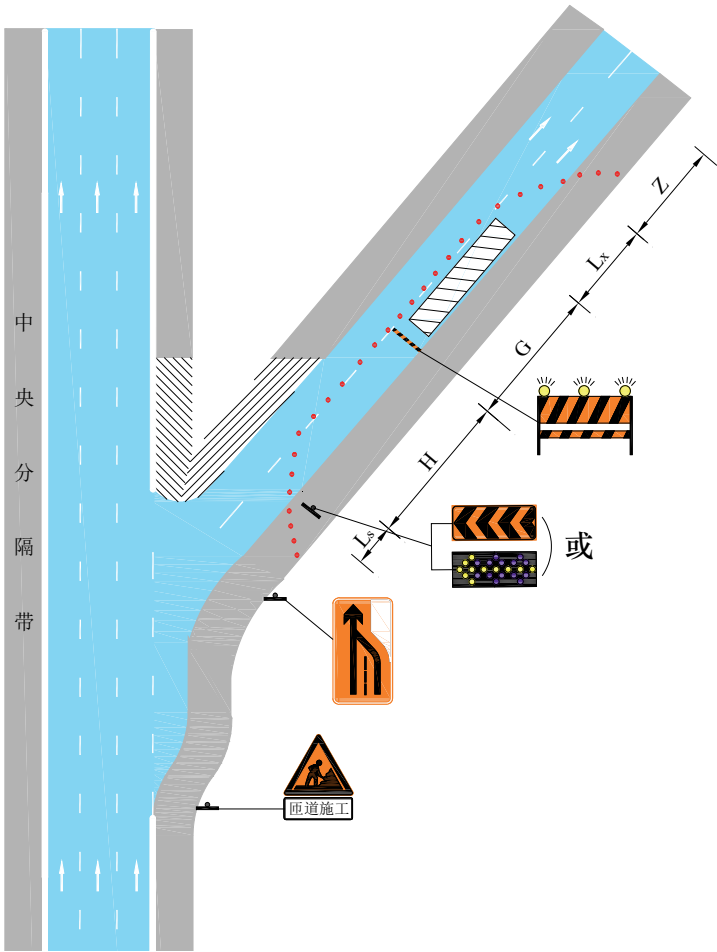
封闭出口匝道外侧车道作业区布置示例
